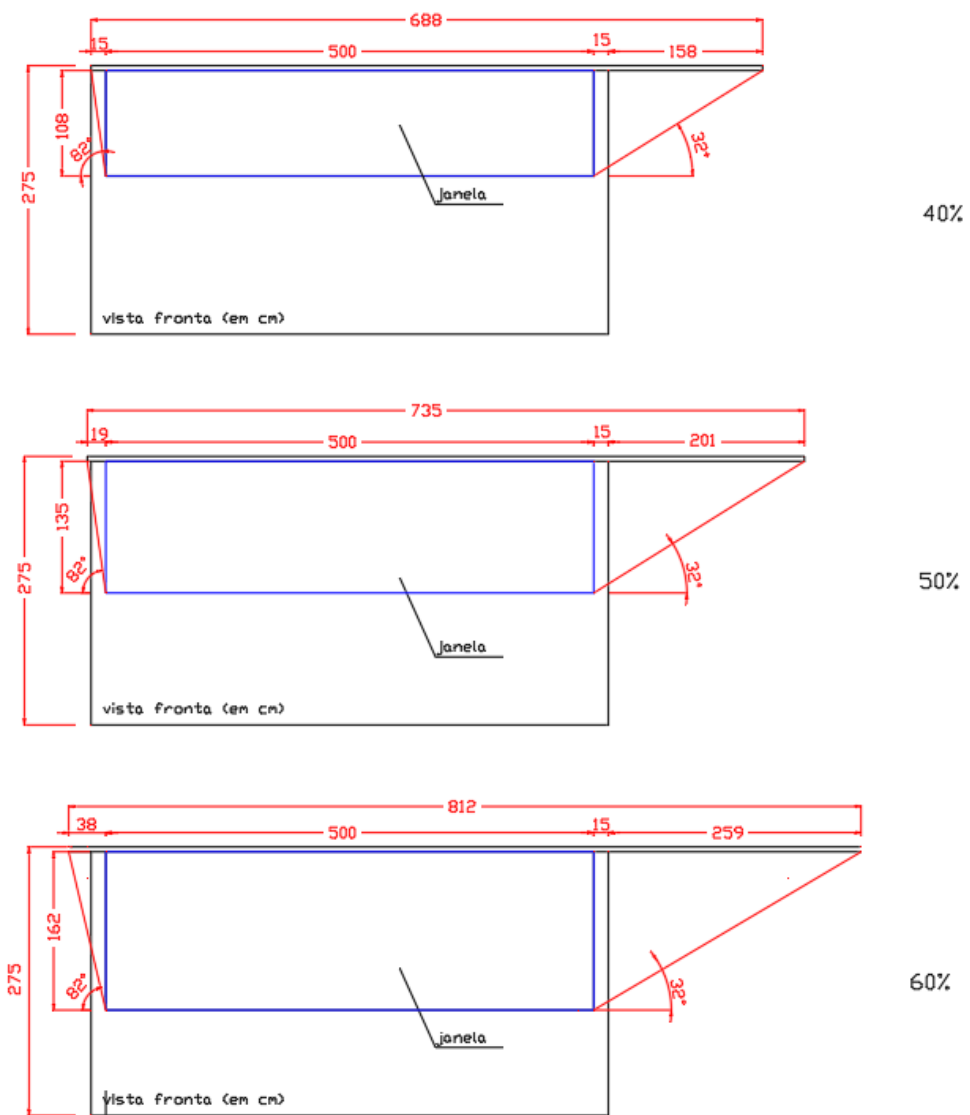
Vista em planta das aberturas de 40%, 50% e 60% com dispositivos de sombreamento para a orientação norte (horizontais).
